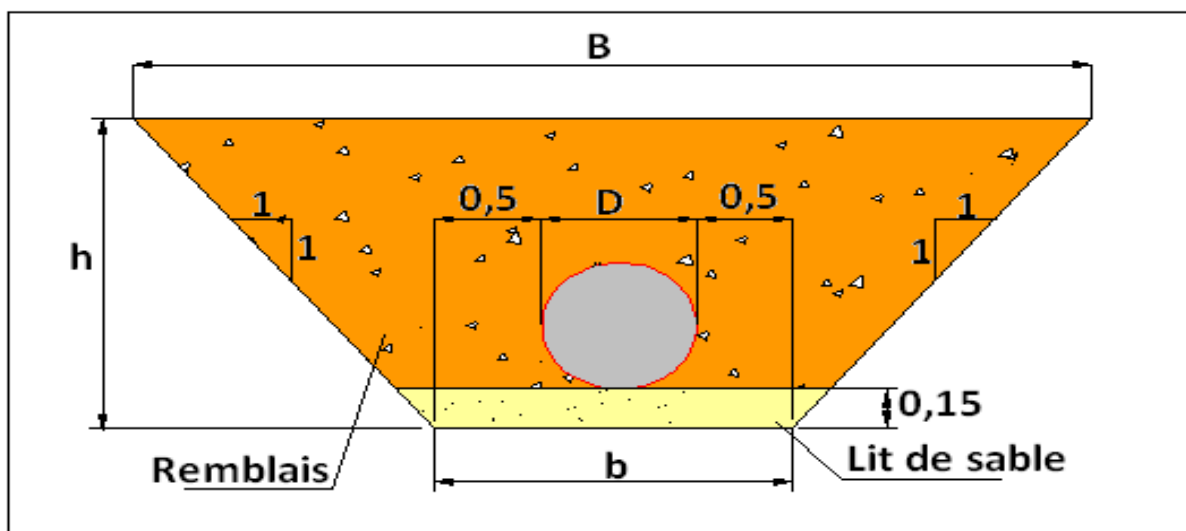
Coupes en travers de la tranchée de la conduite.
